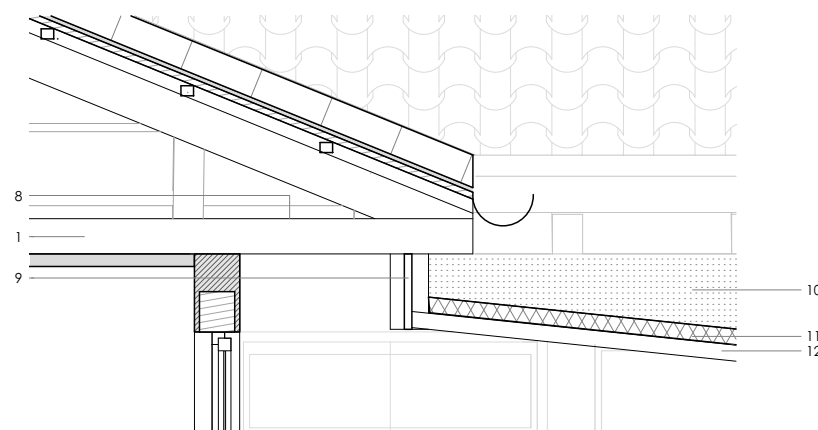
Detalle Constructivo 02. Esc. 1:50
